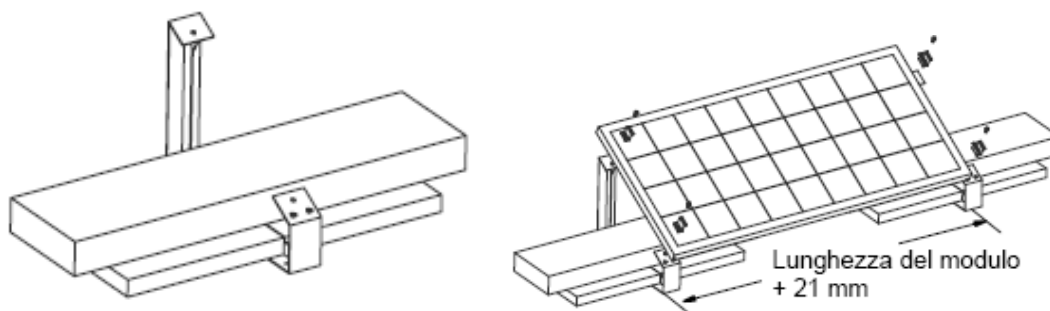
Zavorra di sostegno per tetto piano e dettaglio di installazione modulo
